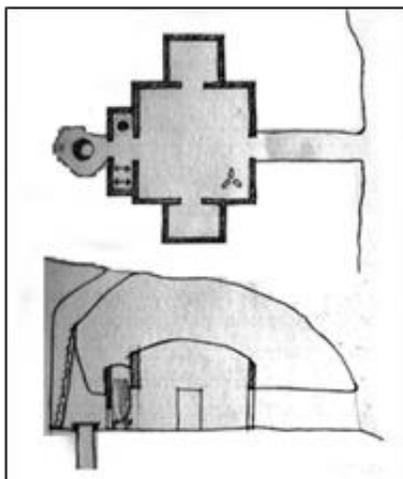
Gruta Mopti Planta y Alzado de Habitación Excavado. Fuente: Camesasca, 1971.
